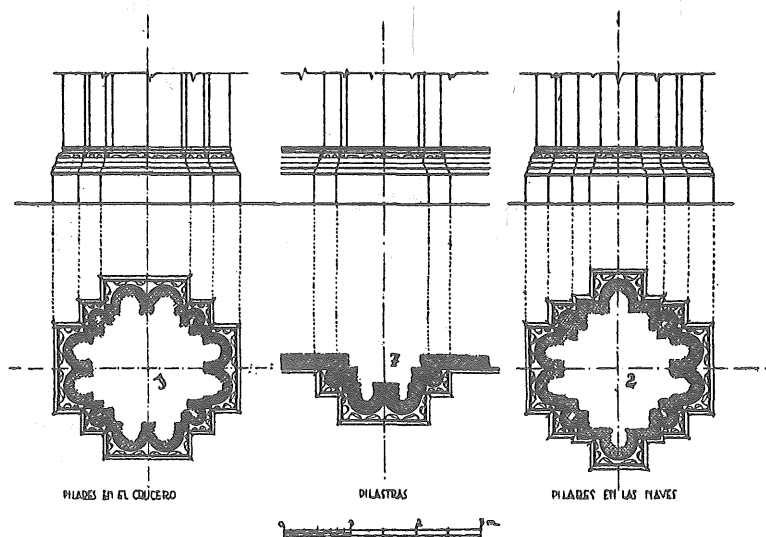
Santo Domingo de la Calzada (Logroño). Plano de los pilares de la catedral. (Dibujo de F. Sáenz Oiza.) Escala: 1 centímetro por metro.
